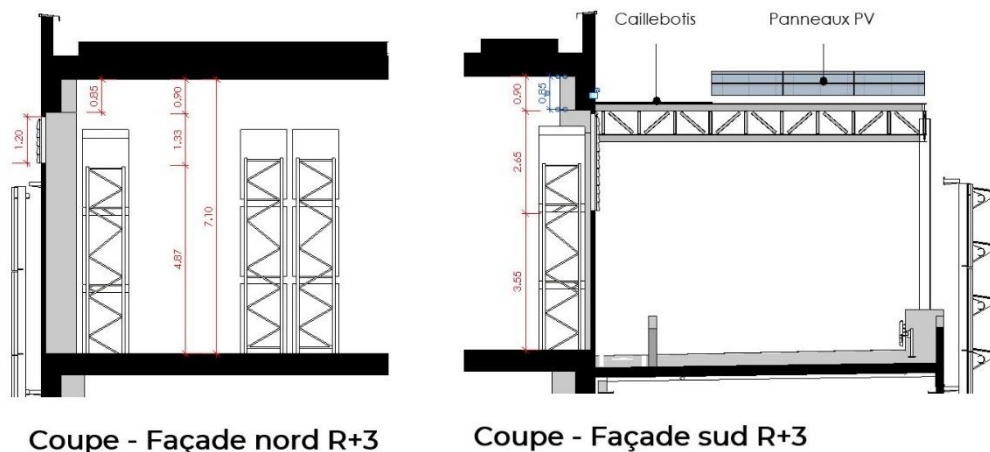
Vues en coupe en façades NORD et SUD d'une cellule du R+3 – Position des ouvrants en façades
